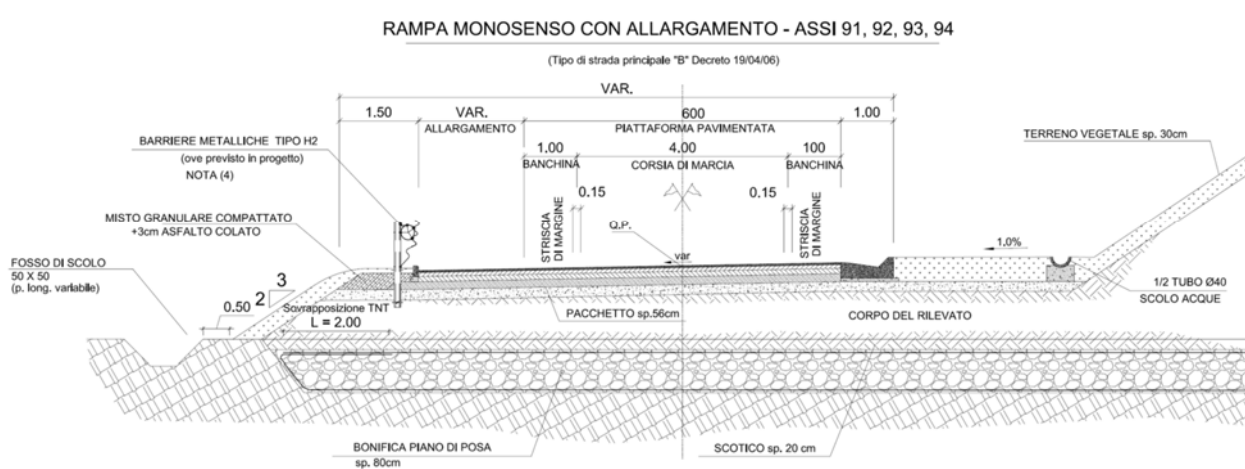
Sezione tipologica dell'asse 91, 92, 93 e 94
